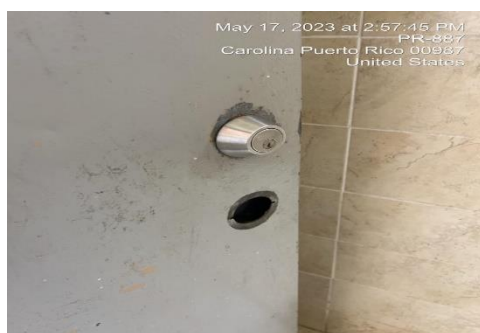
Reemplazar puertas de maderas por puertas de tolas
